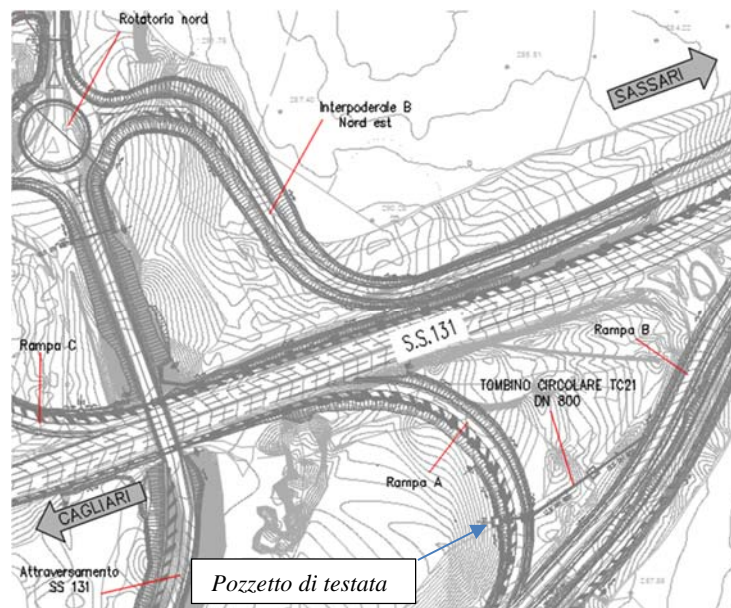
Planimetria nuovo svincolo di Paulilatino, con posizione del pozzetto del tombino TC21
